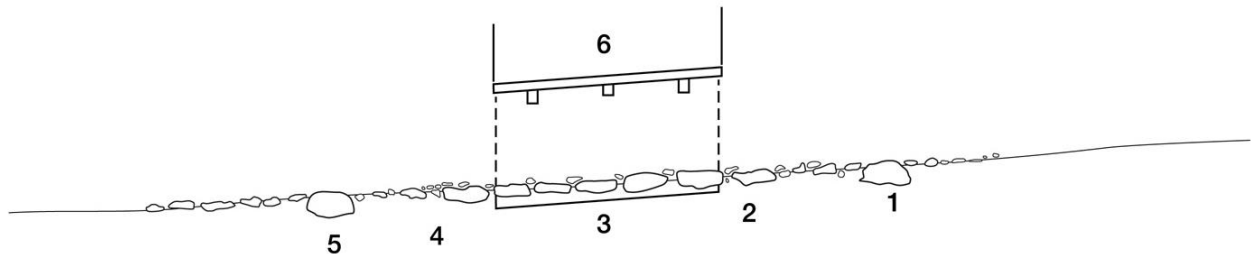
Profil eines Kastendurchlasses mit Holz- oder Stahlabdeckung und Darstellung der feinen Sohlenstruktur
